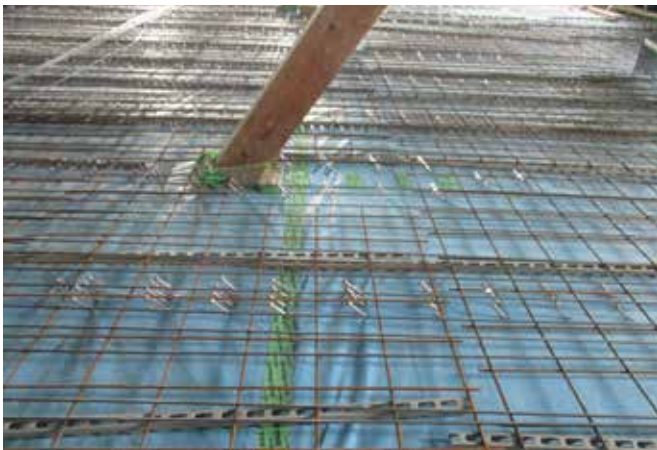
Vorbereitung der Holz-Beton-Verbunddecke
